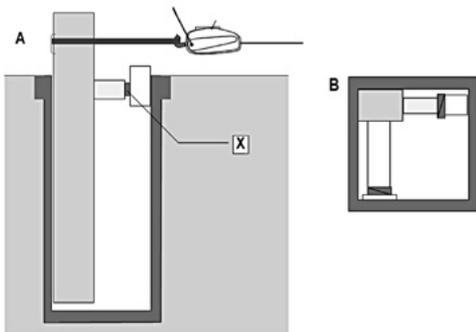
Ancoraggio sulla parete posteriore del pozzetto con cuneo (X), in sezione (A) e in pianta (B)
